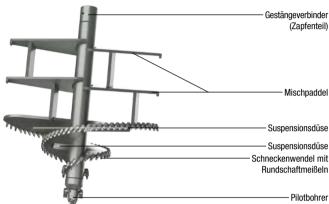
Mischwerkzeug mit Paddeln, Schneckenanfänger und Pilotbohrer mit Rundschaftmeißelbesatz
